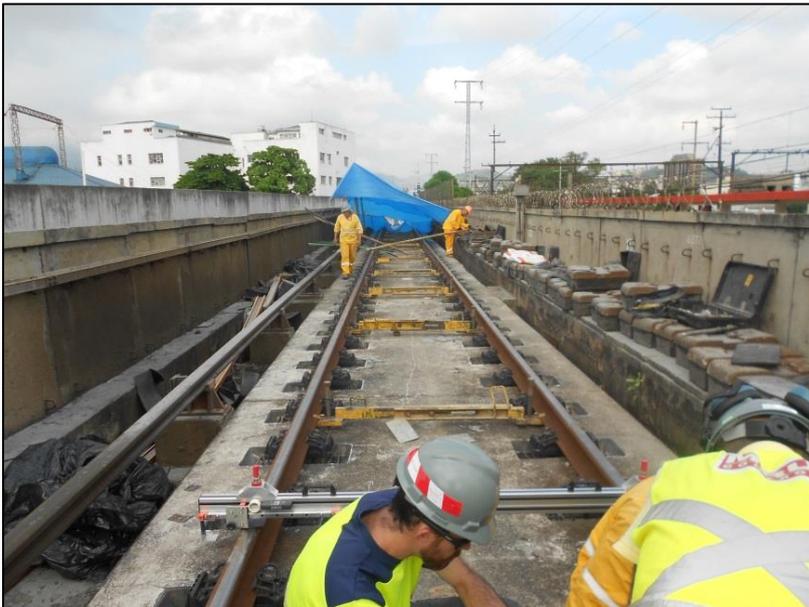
Via abaixada com régulas de travamento e fixações montadas
